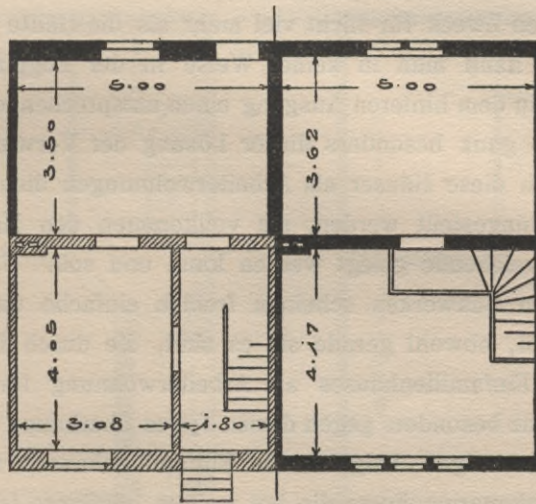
Typ 2a: Im Erdgeschoß zwei, im Obergeschoß ein Wohnraum (Reihenhaus). Beispiel nach einem Haus der Köln-Ehrenfelder Arbeiterwohnungsgenossenschaft. Bauart 4. (Vgl. Festschrift des Rhein. Vereins.)
